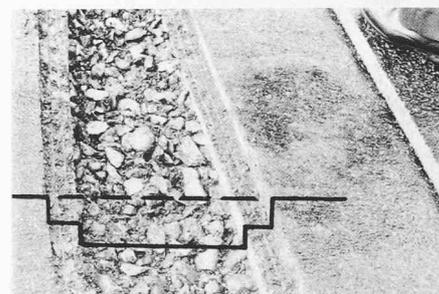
Aufgefräste Naht/Riss, Querschnitt T-förmig, sichtbar ist die Sickerschicht
